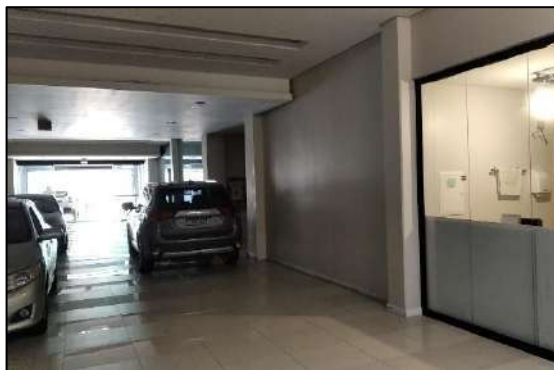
e 08 – Vistoria interna – Vista da escada rolante a partir da Loja 07 no pavimento subsolo.
